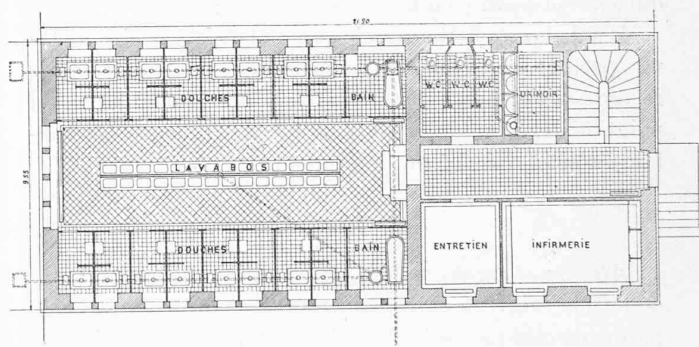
Bâtiment de service. — Plan du rez-de-chaussée.
